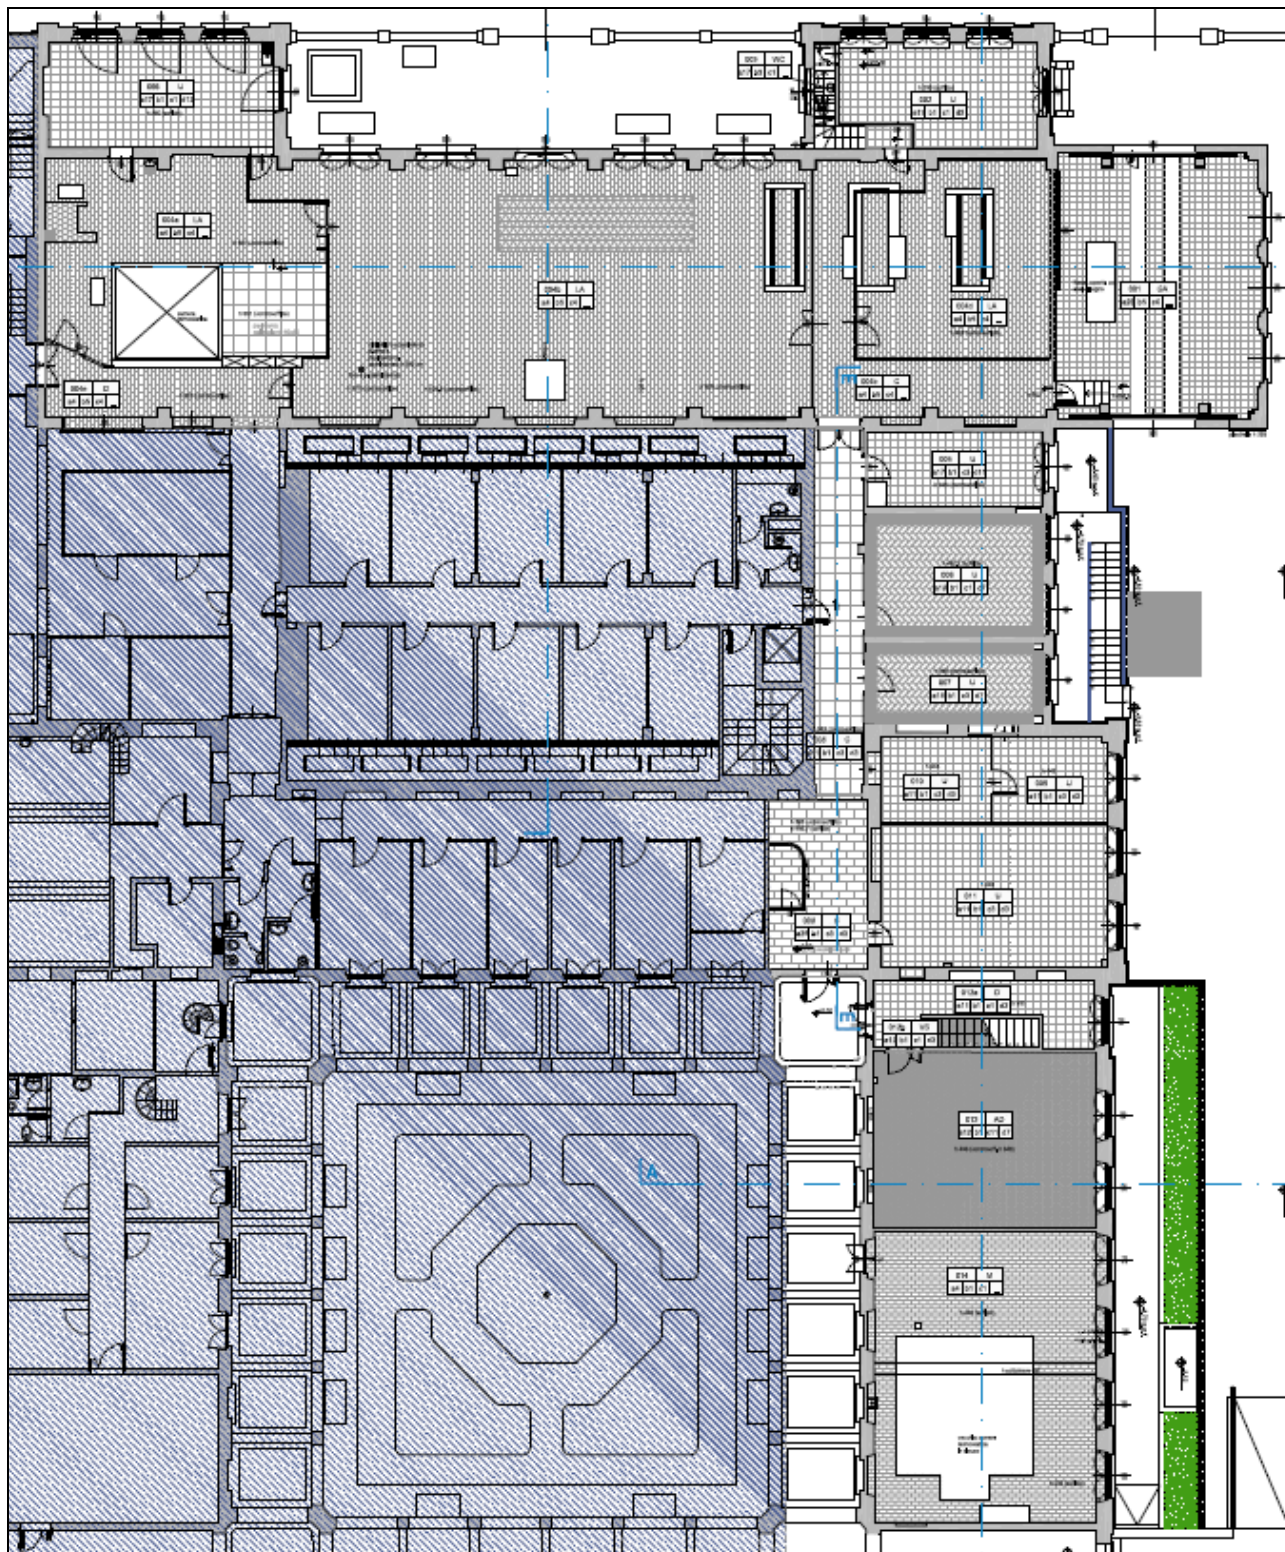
Pianta piano rialzato – Lotto 1
